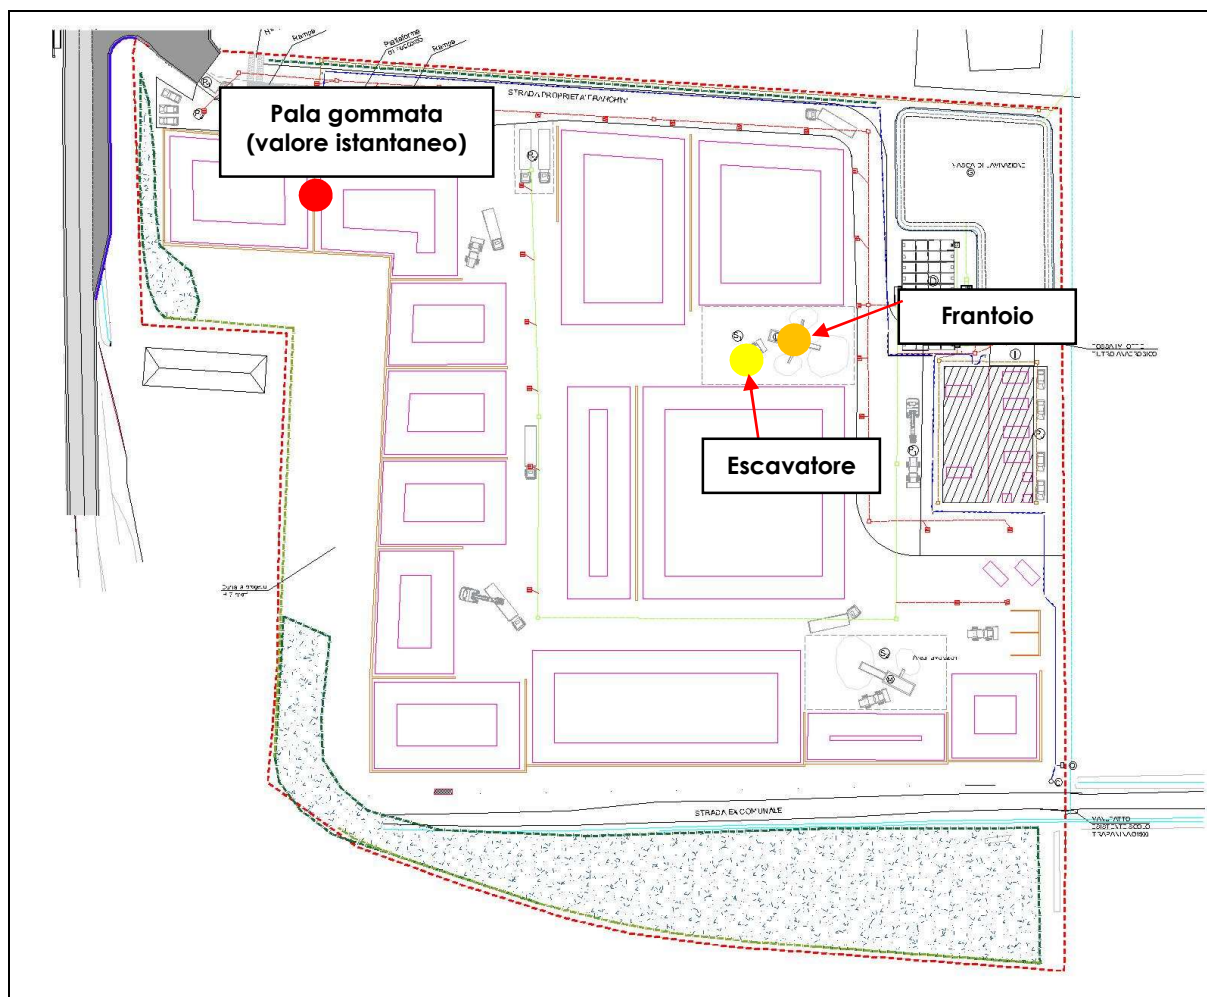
Disposizione in pianta delle sorgenti all'interno dell'area di lavoro
